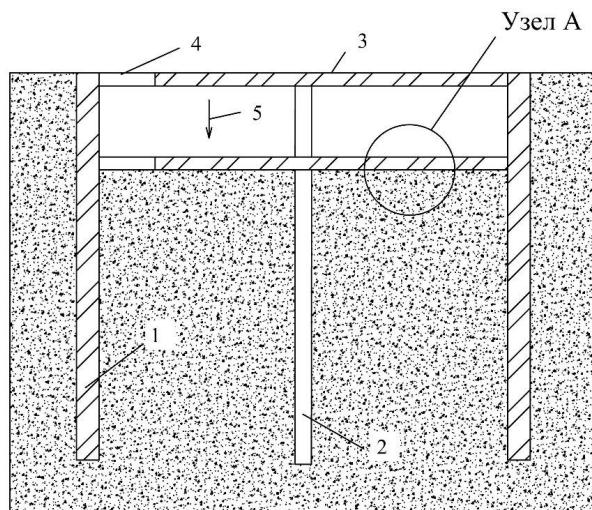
Опережающее возведение перекрытий: 1 – ограждающая конструкция котлована; 2 – временная или постоянная опора; 3 – междуэтажное железобетонное перекрытие; 4 – технологический проем в перекрытии; 5 – направление производства работ
